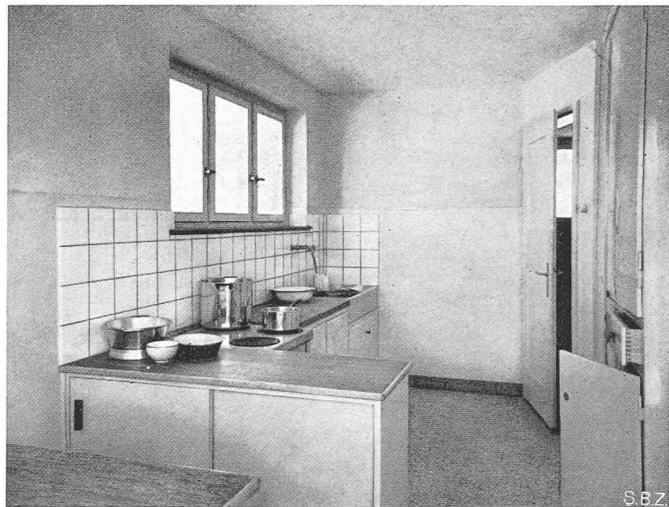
Küche mit Essecke im Vordergrund und Arbeitsecke im Hintergrund. Legende zu den Grundrissen auf Seite 353:
